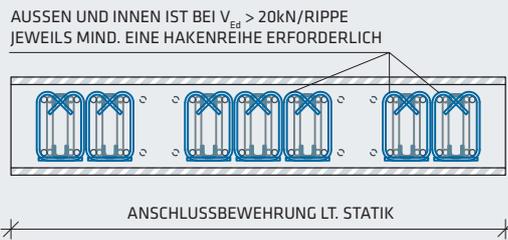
Bauseitige Bewehrung SL-TKM und SL-TKA (Grundriss und Schnitt A)
